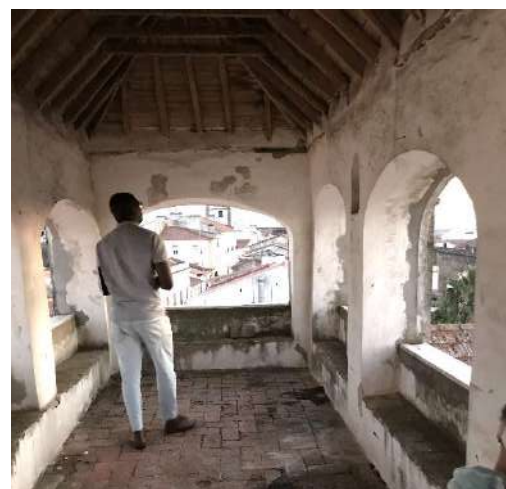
Piso 3 - Mirante (1) - Pavimento em tijoleira tradicional
